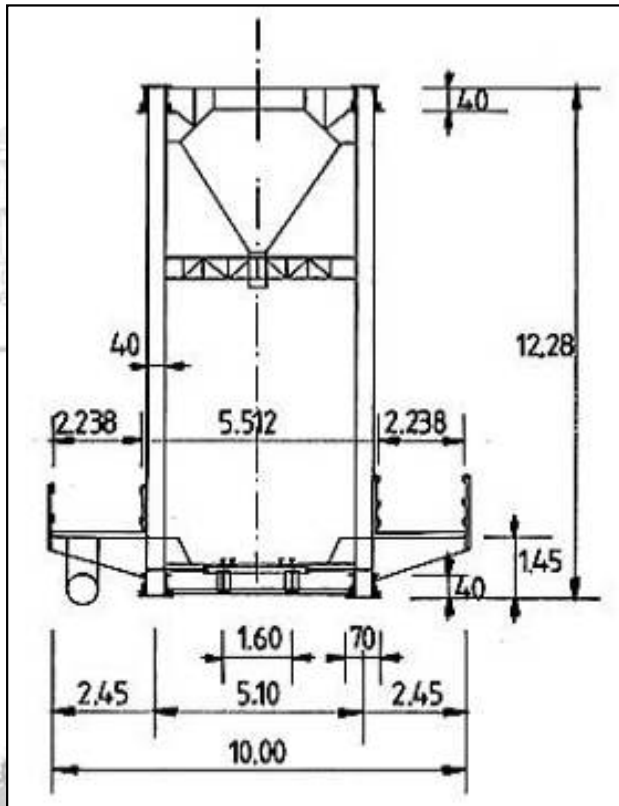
ábra., 41-42. kép. London (Anglia), Tower Bridge [www.365tickets.co.uk, www.wikipedia.org, www.hir.ma.hu]
